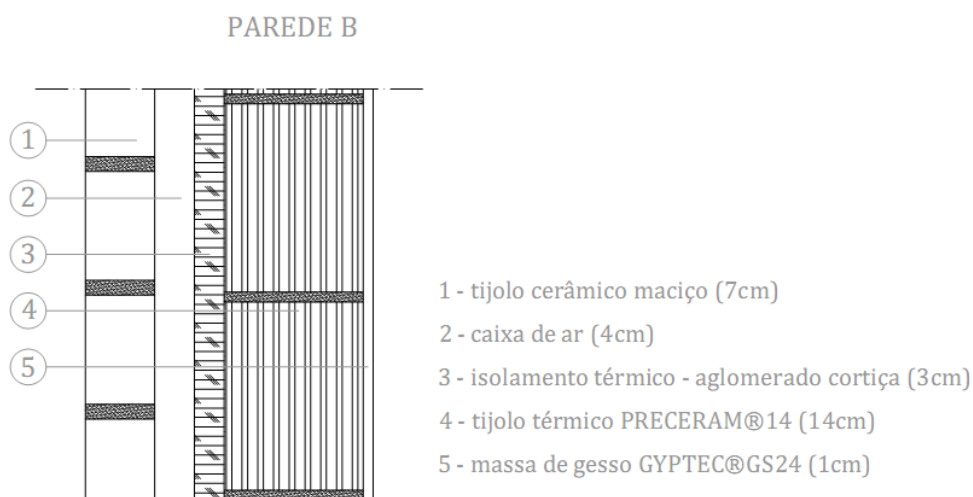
Parede dupla de alvenaria com tijolo térmico (pano interior) e maciço (pano exterior) [Parede B] (esp.: 0,29m)
